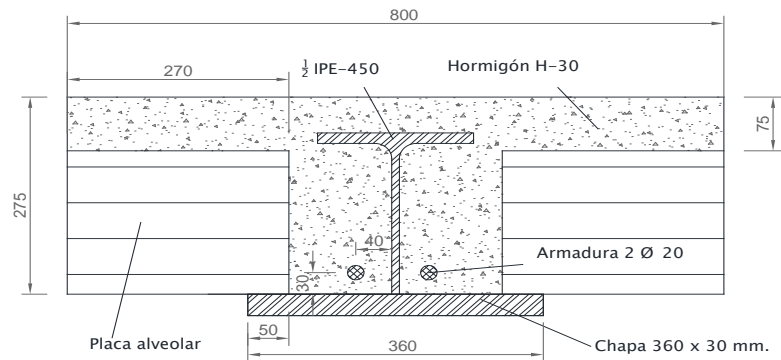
Sección de la viga A3. Tipo IFB. (cotas en mm)
